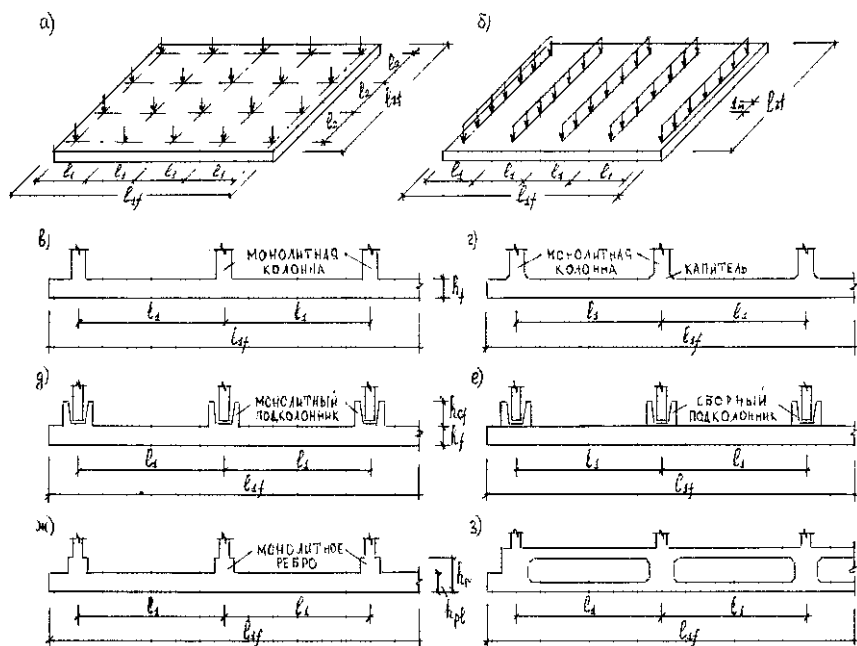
Конструктивные решения сплошных фундаментов: а – под сетку колонн, б – под несущие стены, в, г – плоские под монолитные железобетонные колонны, д, е – плоские под сборные железобетонные колонны, ж – плитно-балочные (ребристые), з – коробчатые
